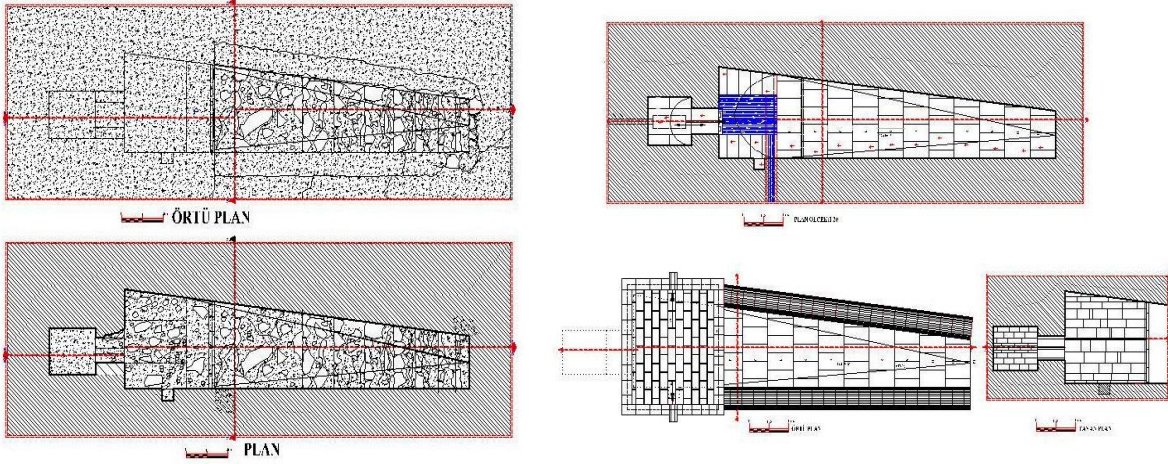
,4. Mahallebaşı Çeşmesi Rölöve ve Restitüsyon Vaziyet Planı (Ş. Öztürk-2023)
